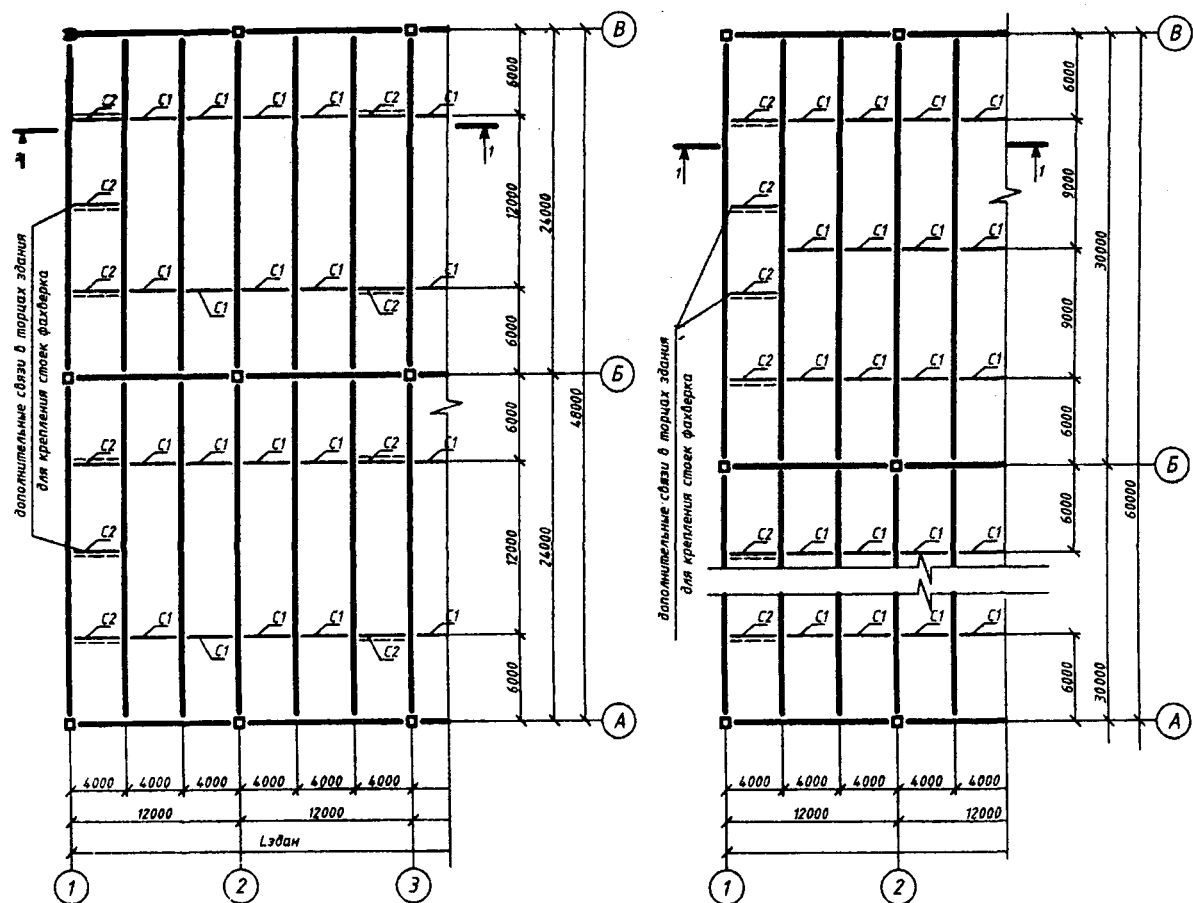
Схема расположения связей в покрытии поэлементного монтажа при пролетах ферм 24 и 30 м
